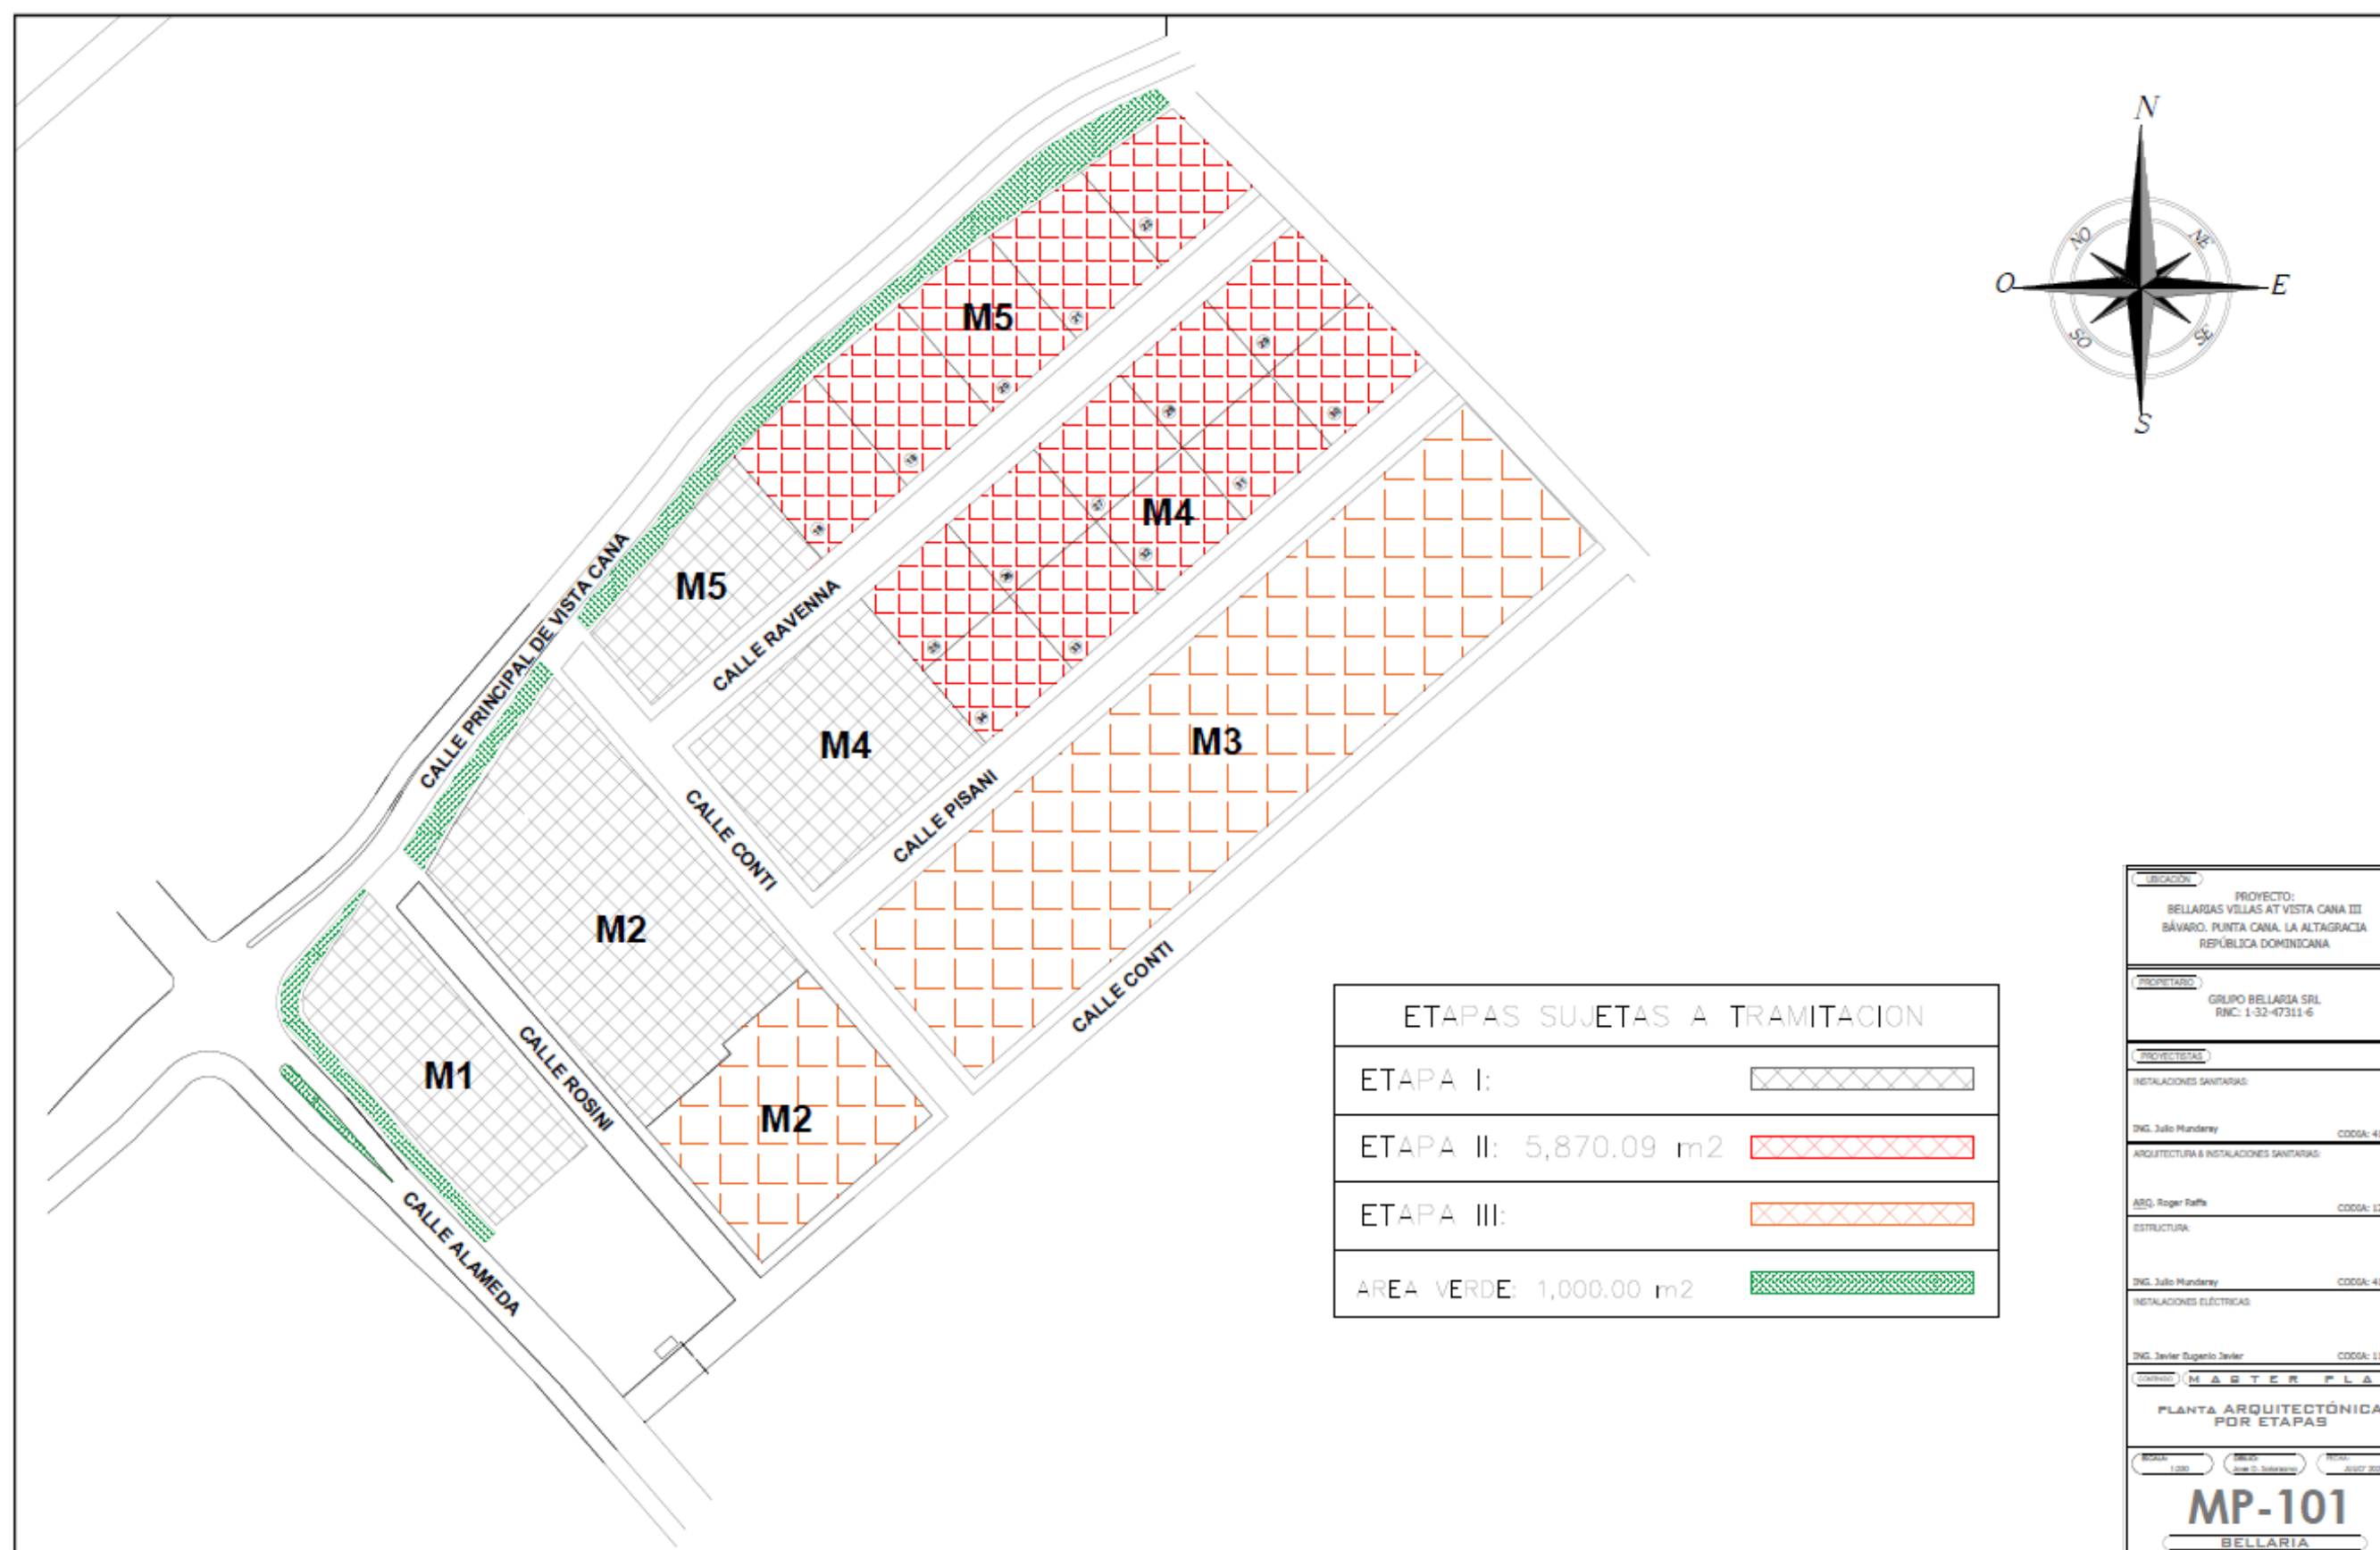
Plano de conjunto destacando el área verde del proyecto.
